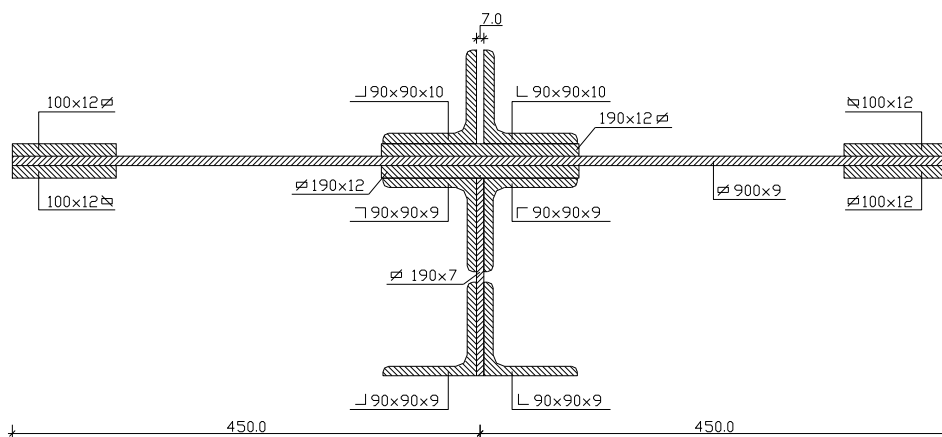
Secção do montante sobre o pilar corrente - MON_PC
